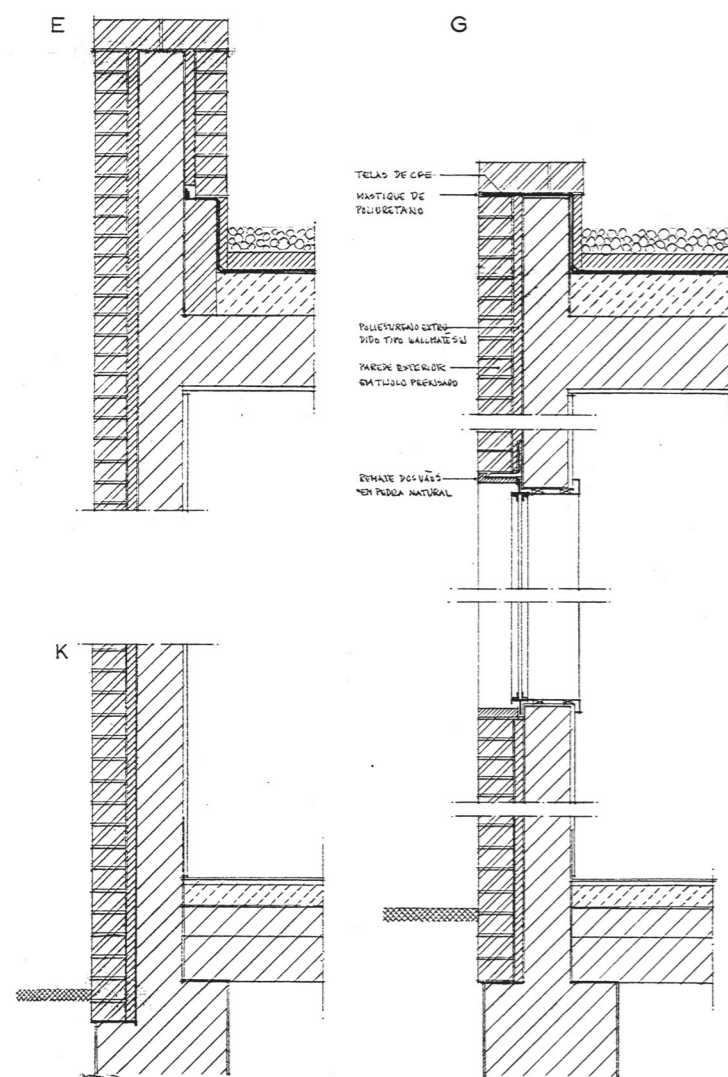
Departamento de Engenharia Cerâmica e do Vidro da Universidade de Aveiro. Pormenorizações de fachada corrida em tijolo-à-vista, parcialmente suportada por cantoneiras de aço.
